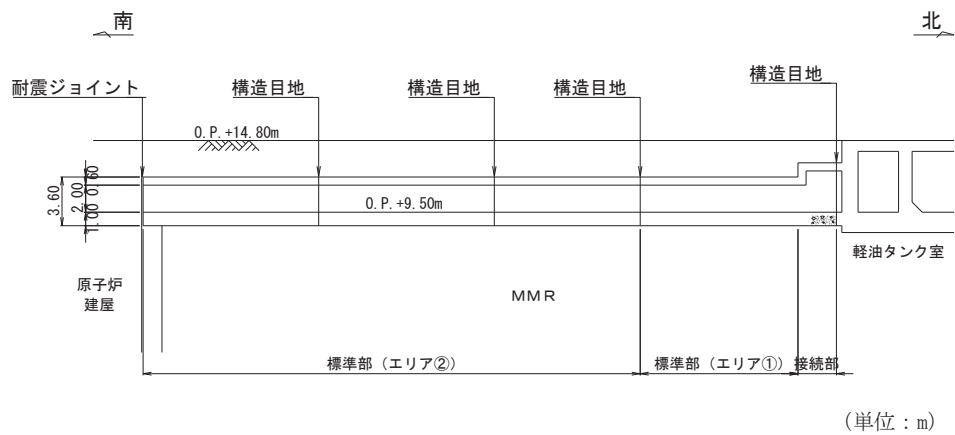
(3) 軽油タンク連絡ダクト縦断面図 (C-C 断面)
